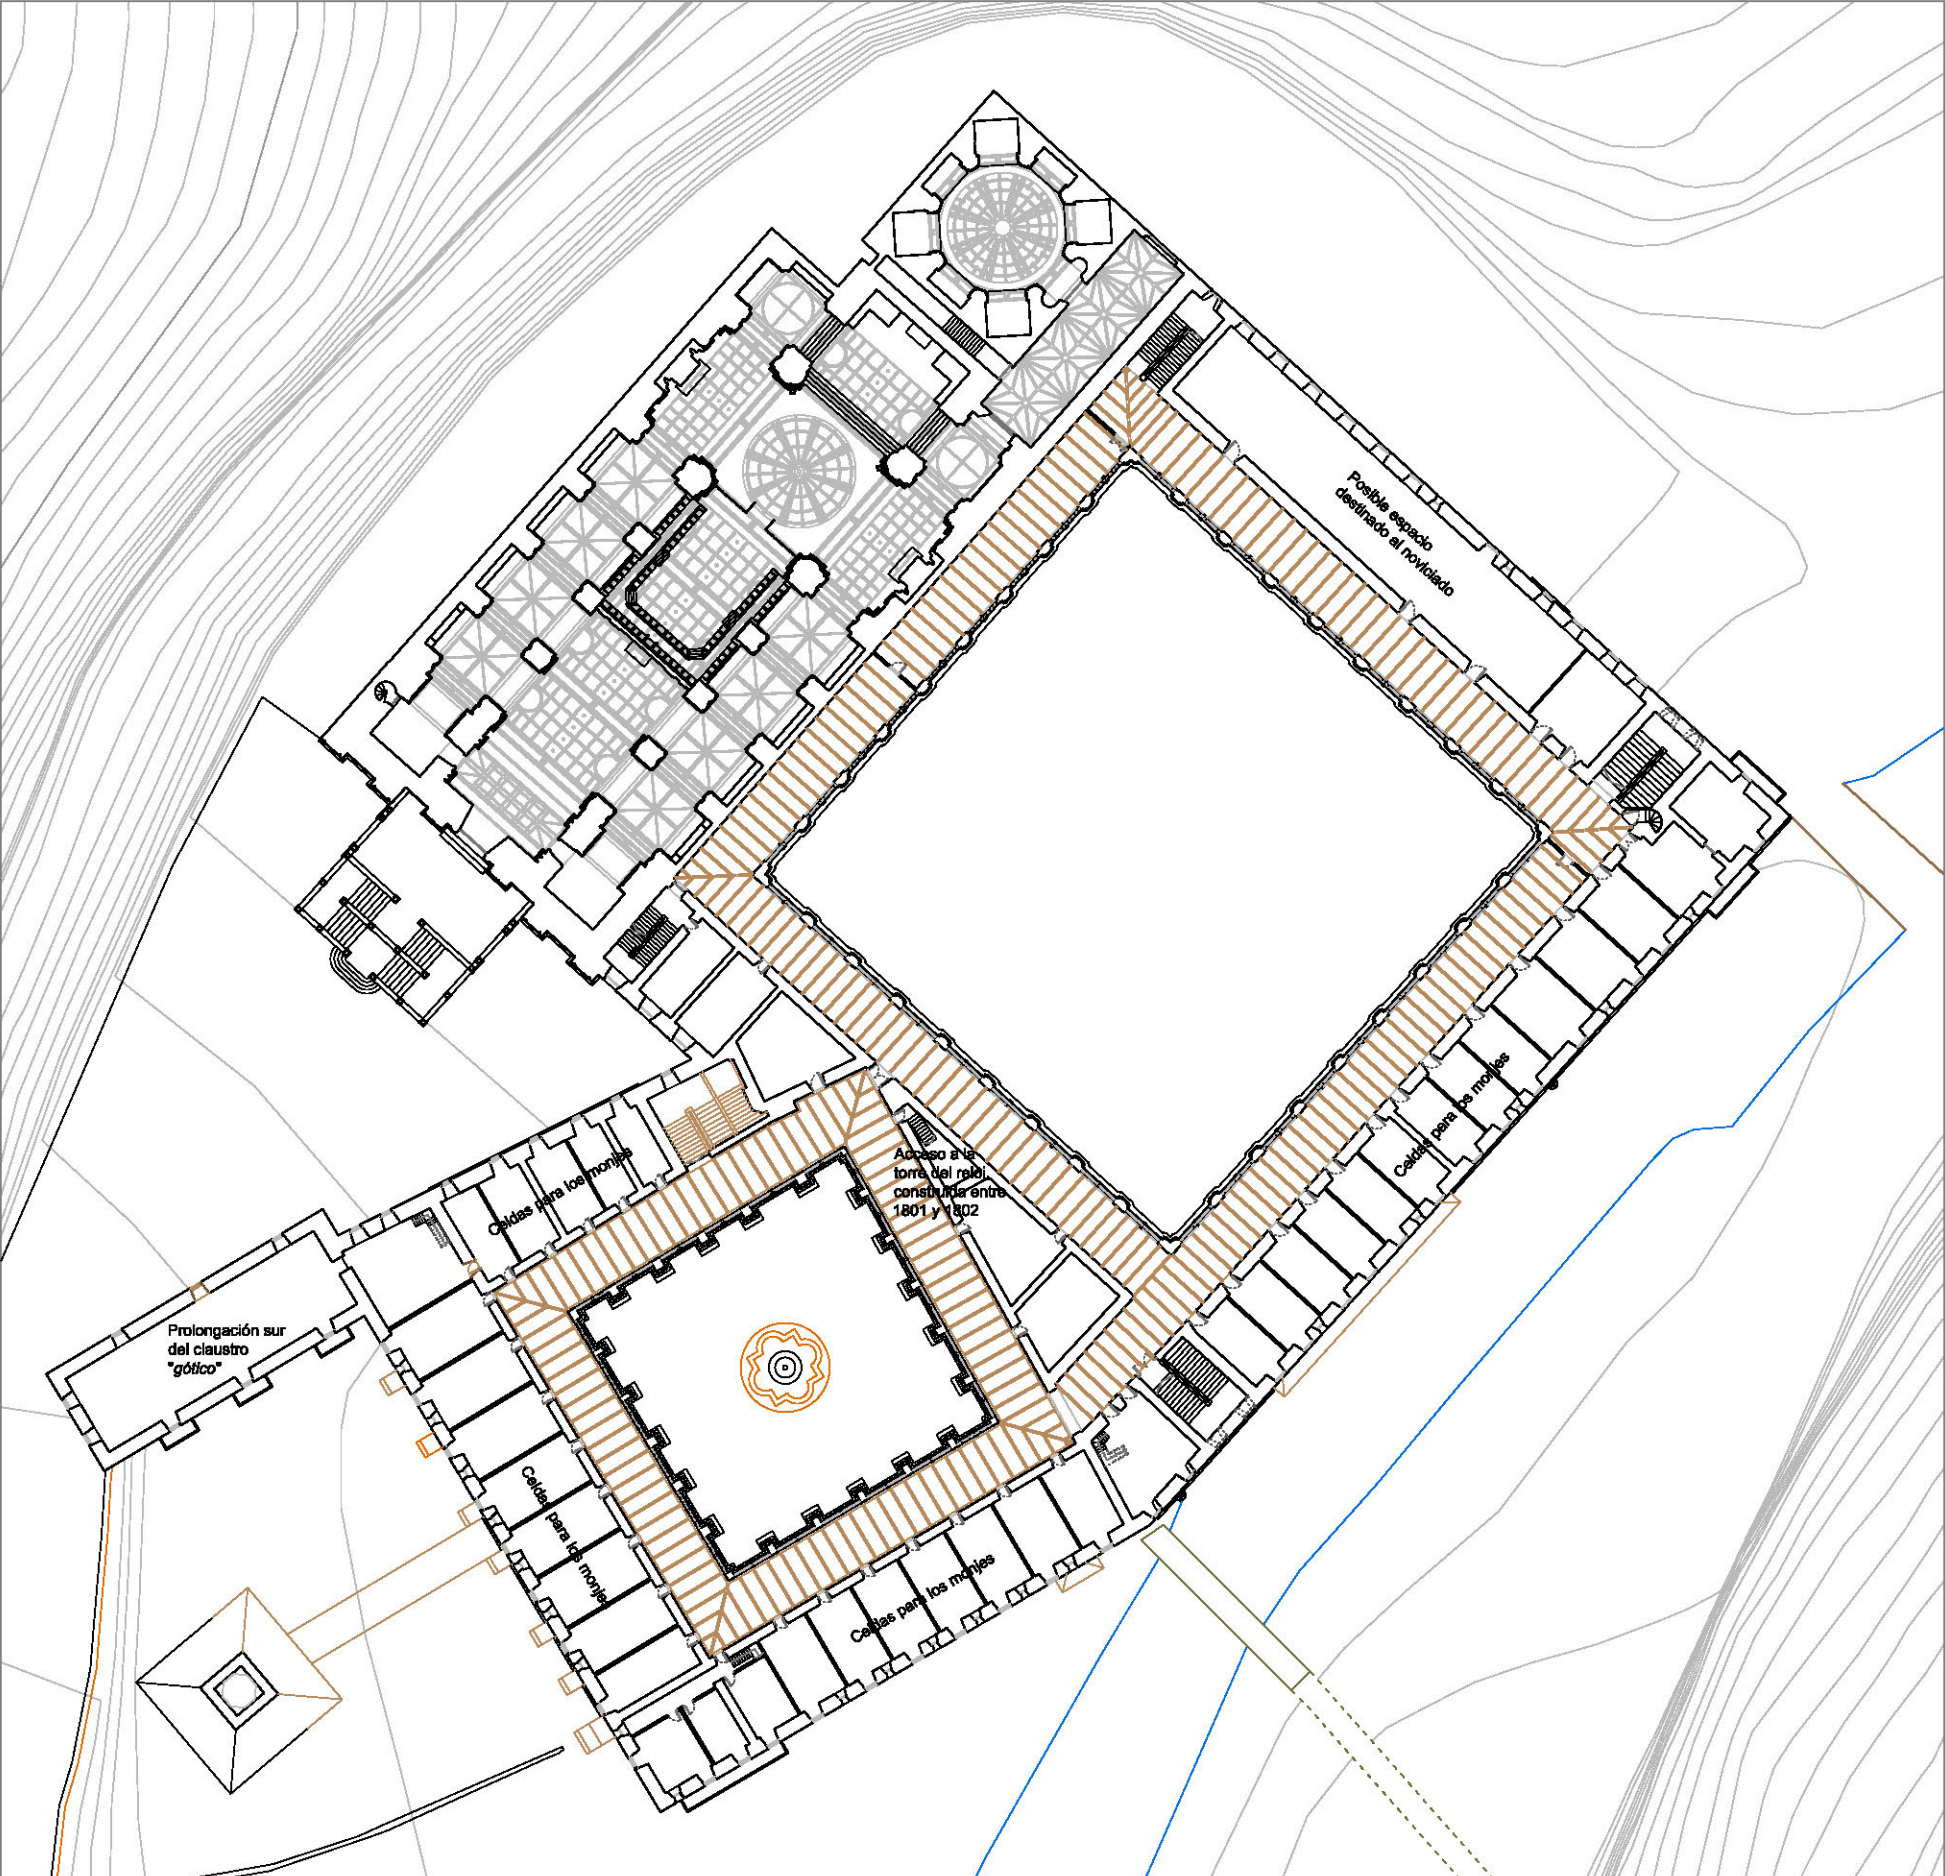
Detalle de la planta segunda del claustro “gótico”
